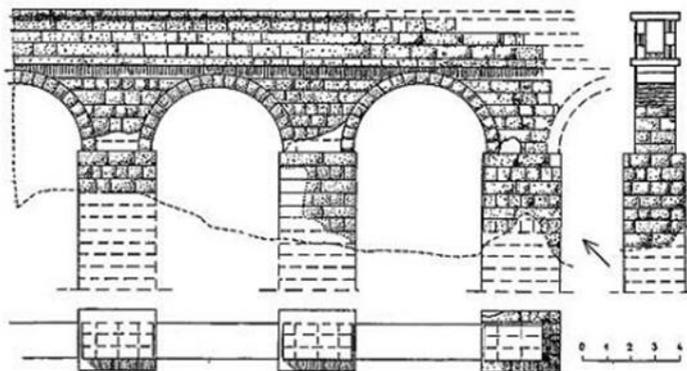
Акведук Марция, 140 г. до н. э. Фасад, разрез и план
